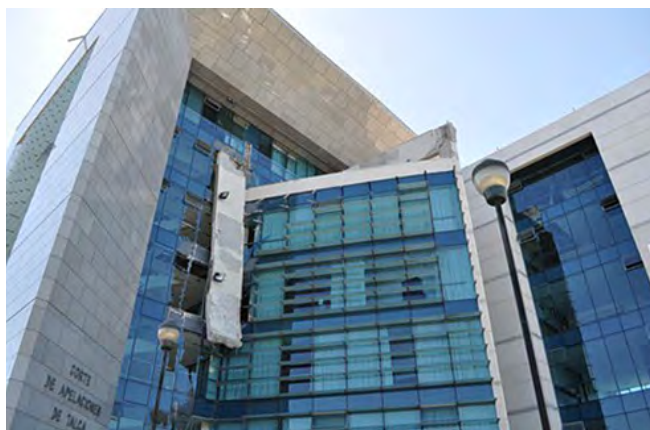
> Rupture transversale au plan du parapet, grand risque de chute
